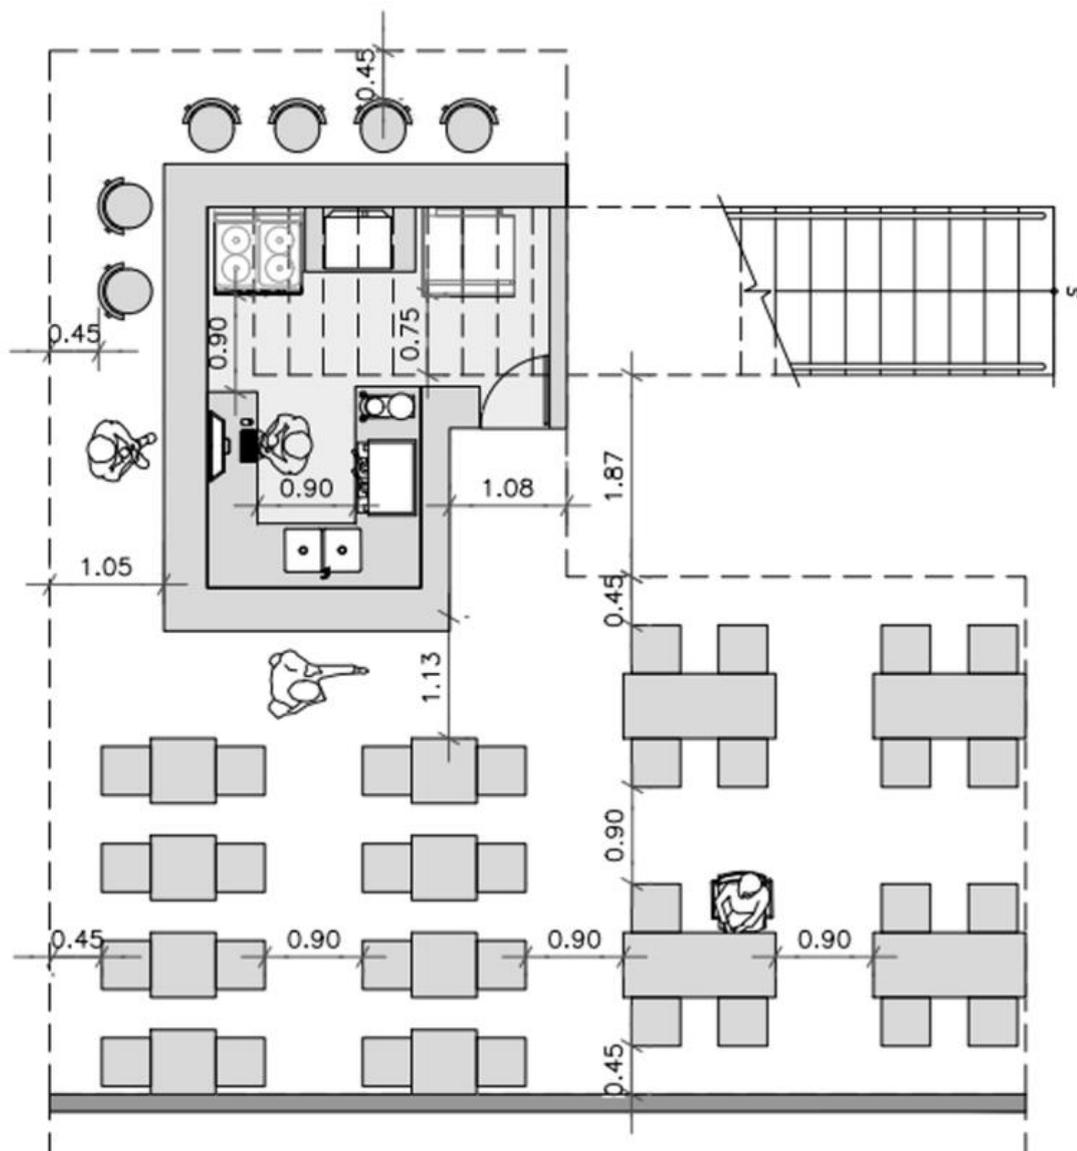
Planta Baixa Térreo: ÁREA DE USO OPERACIONAL E ÁREA DE INFLUÊNCIA
